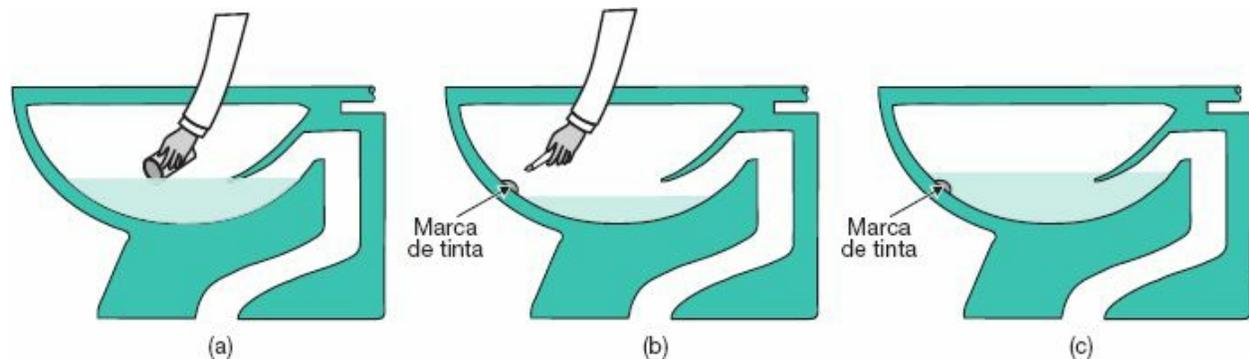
Teste de vazamento em aparelhos sanitários.
